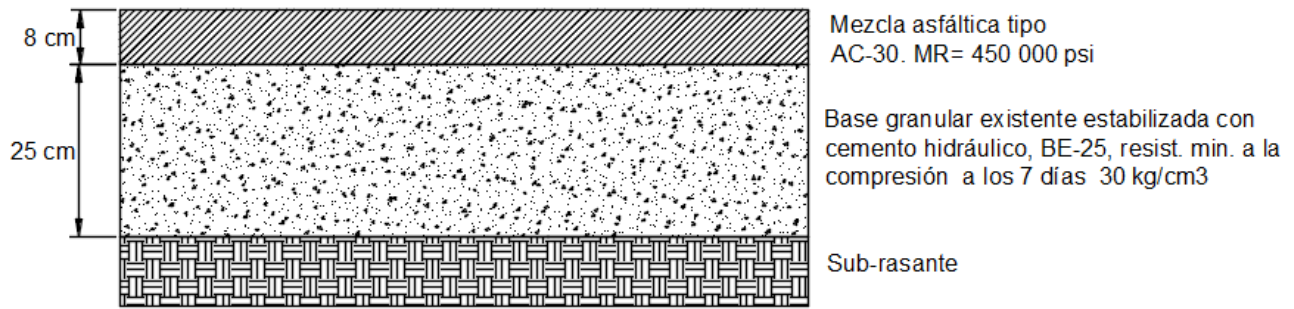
Perfil de la estructura de pavimento propuesta para el TH=29, P#2.
